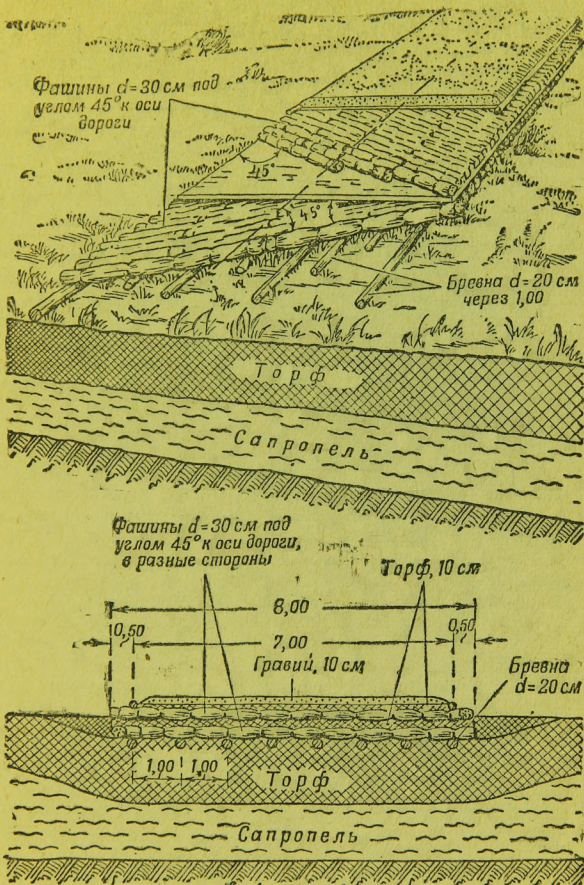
Двухрядный фашинный тюфяк с косым расположением фашин
